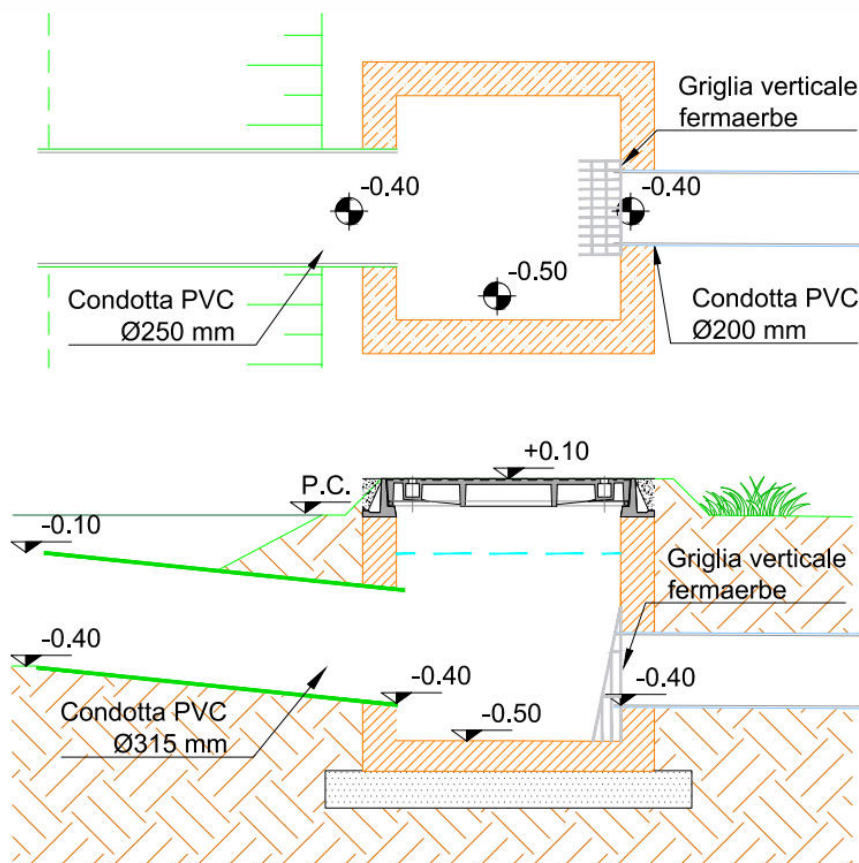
Pianta e sezioni tipologiche del manufatto di laminazione.
